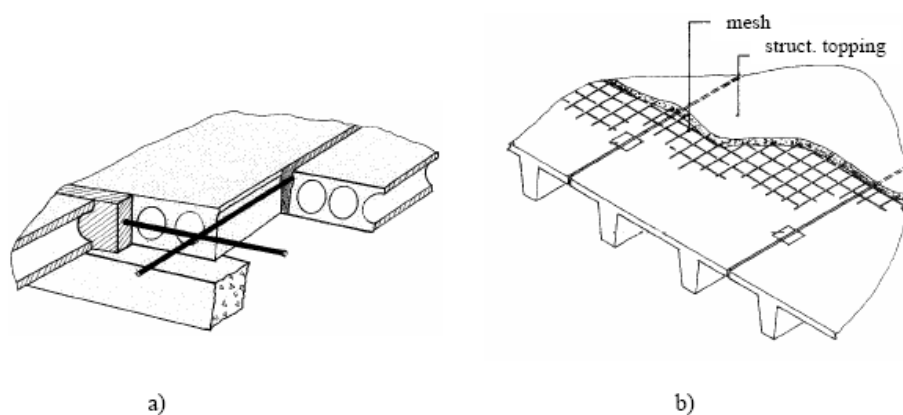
Pisos típicos, a) laje alveolar, b) laje duplo “T” (FIB, 2008)
